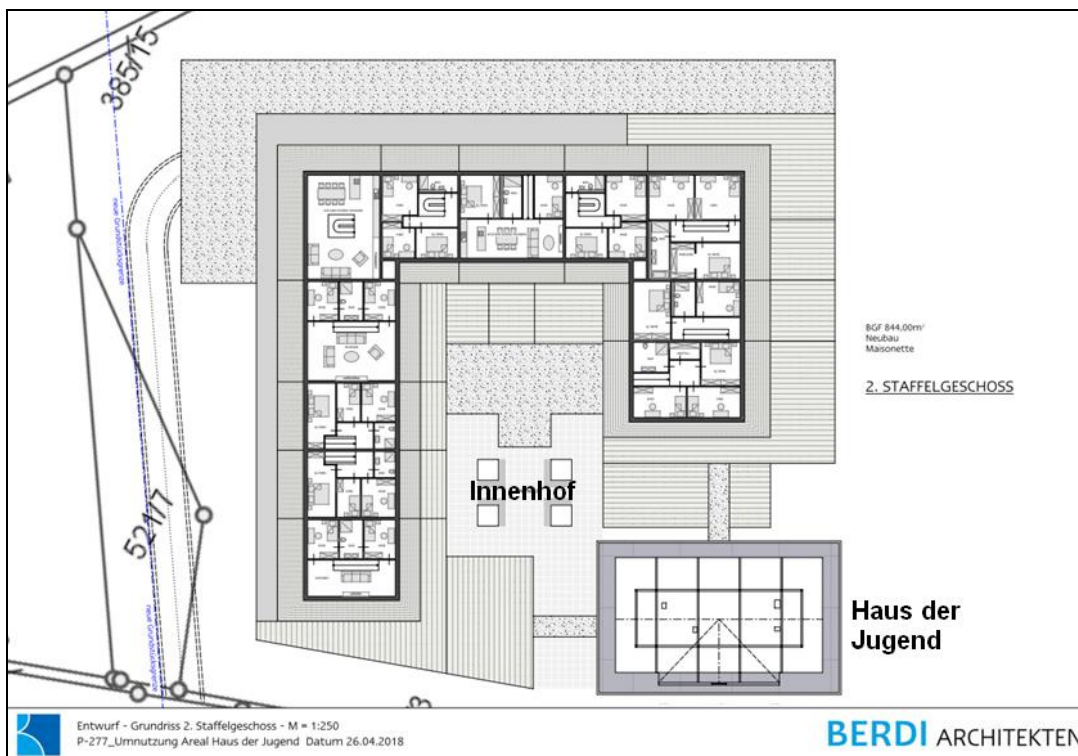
Grundriss 2. Staffelgeschoss (Maisonette-Wohnungen)
